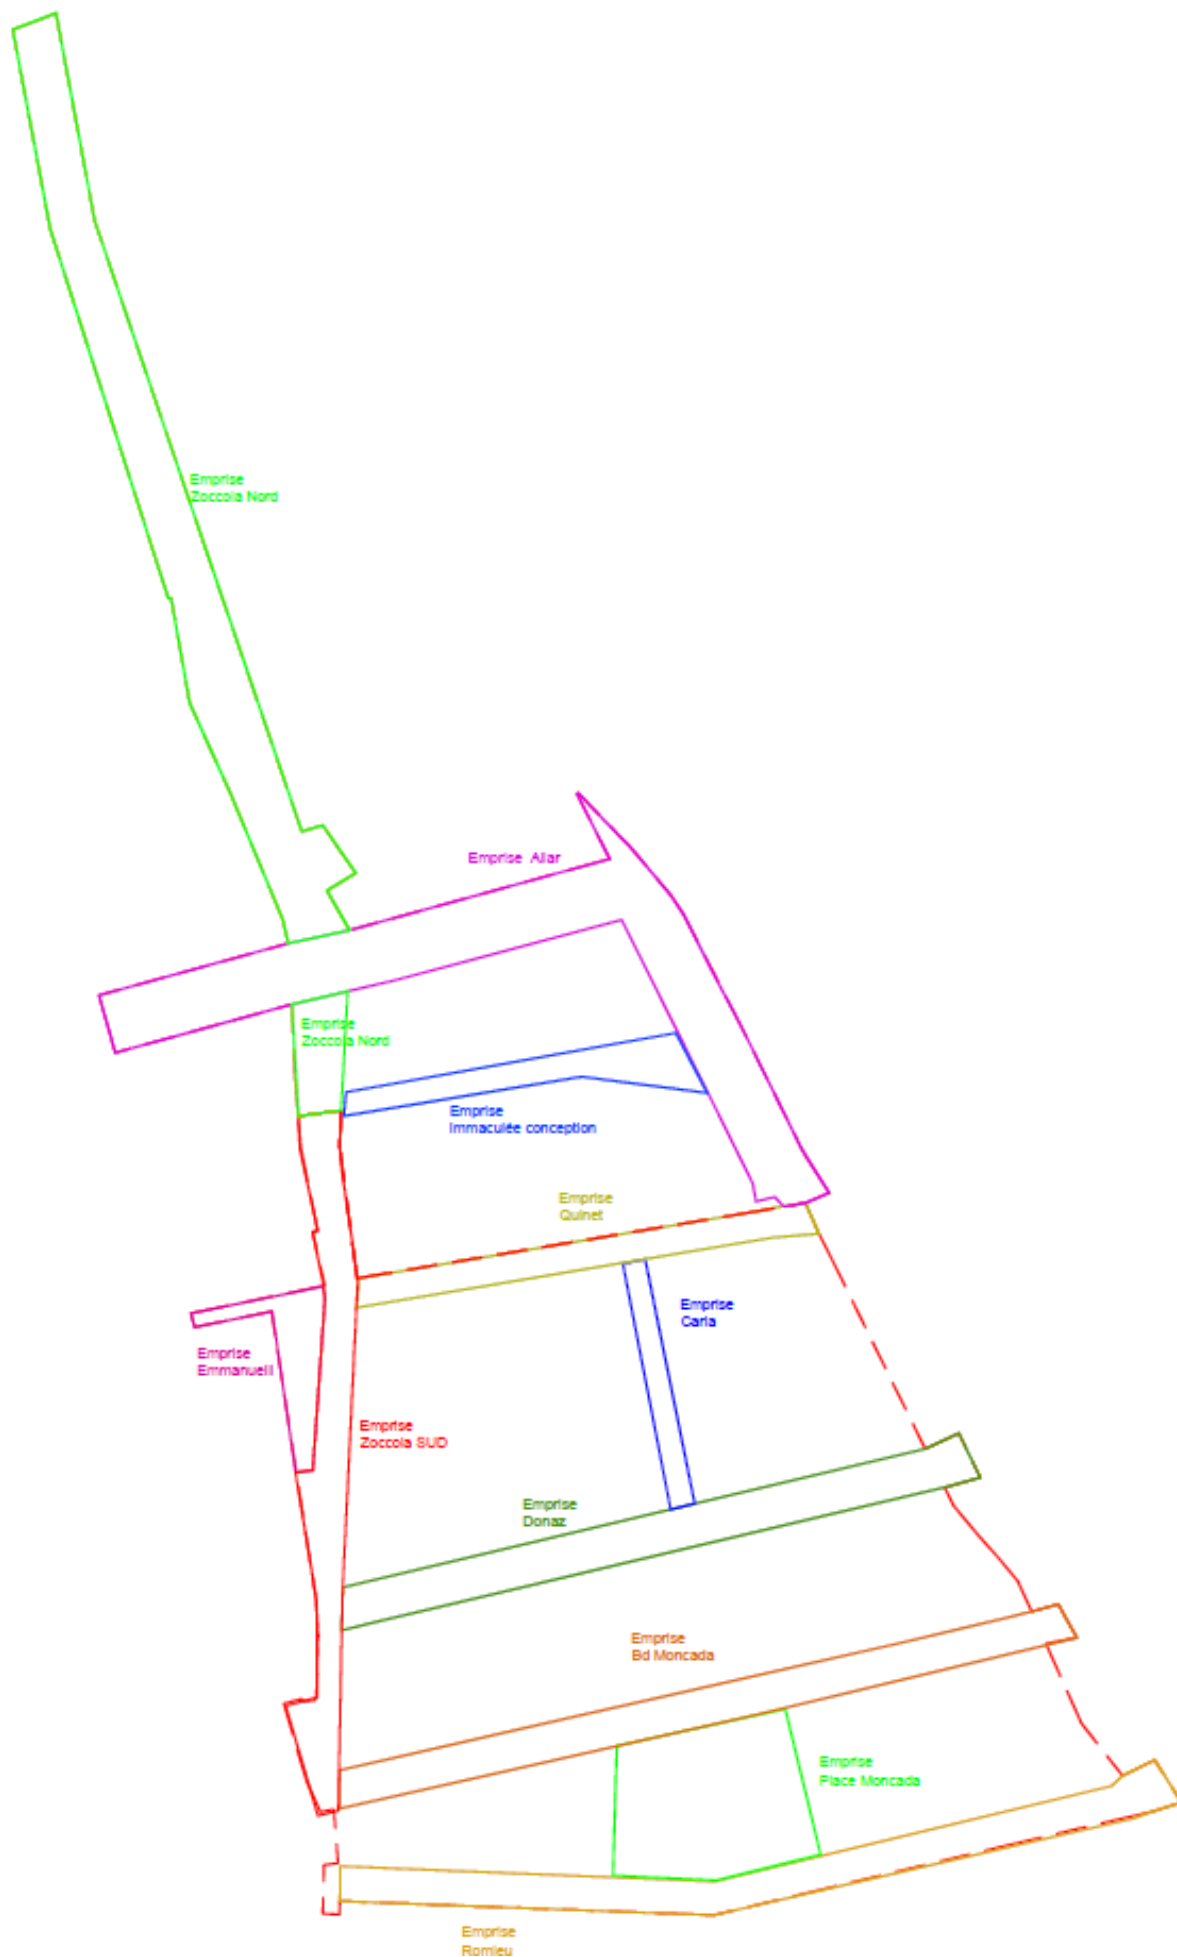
Plan de situation du projet (périmètres « Planche Sud » - « Planche Nord »)
